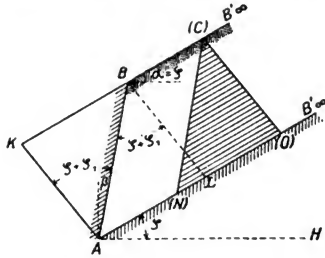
Erddruck bei gebrochener Erdoberfläche.
